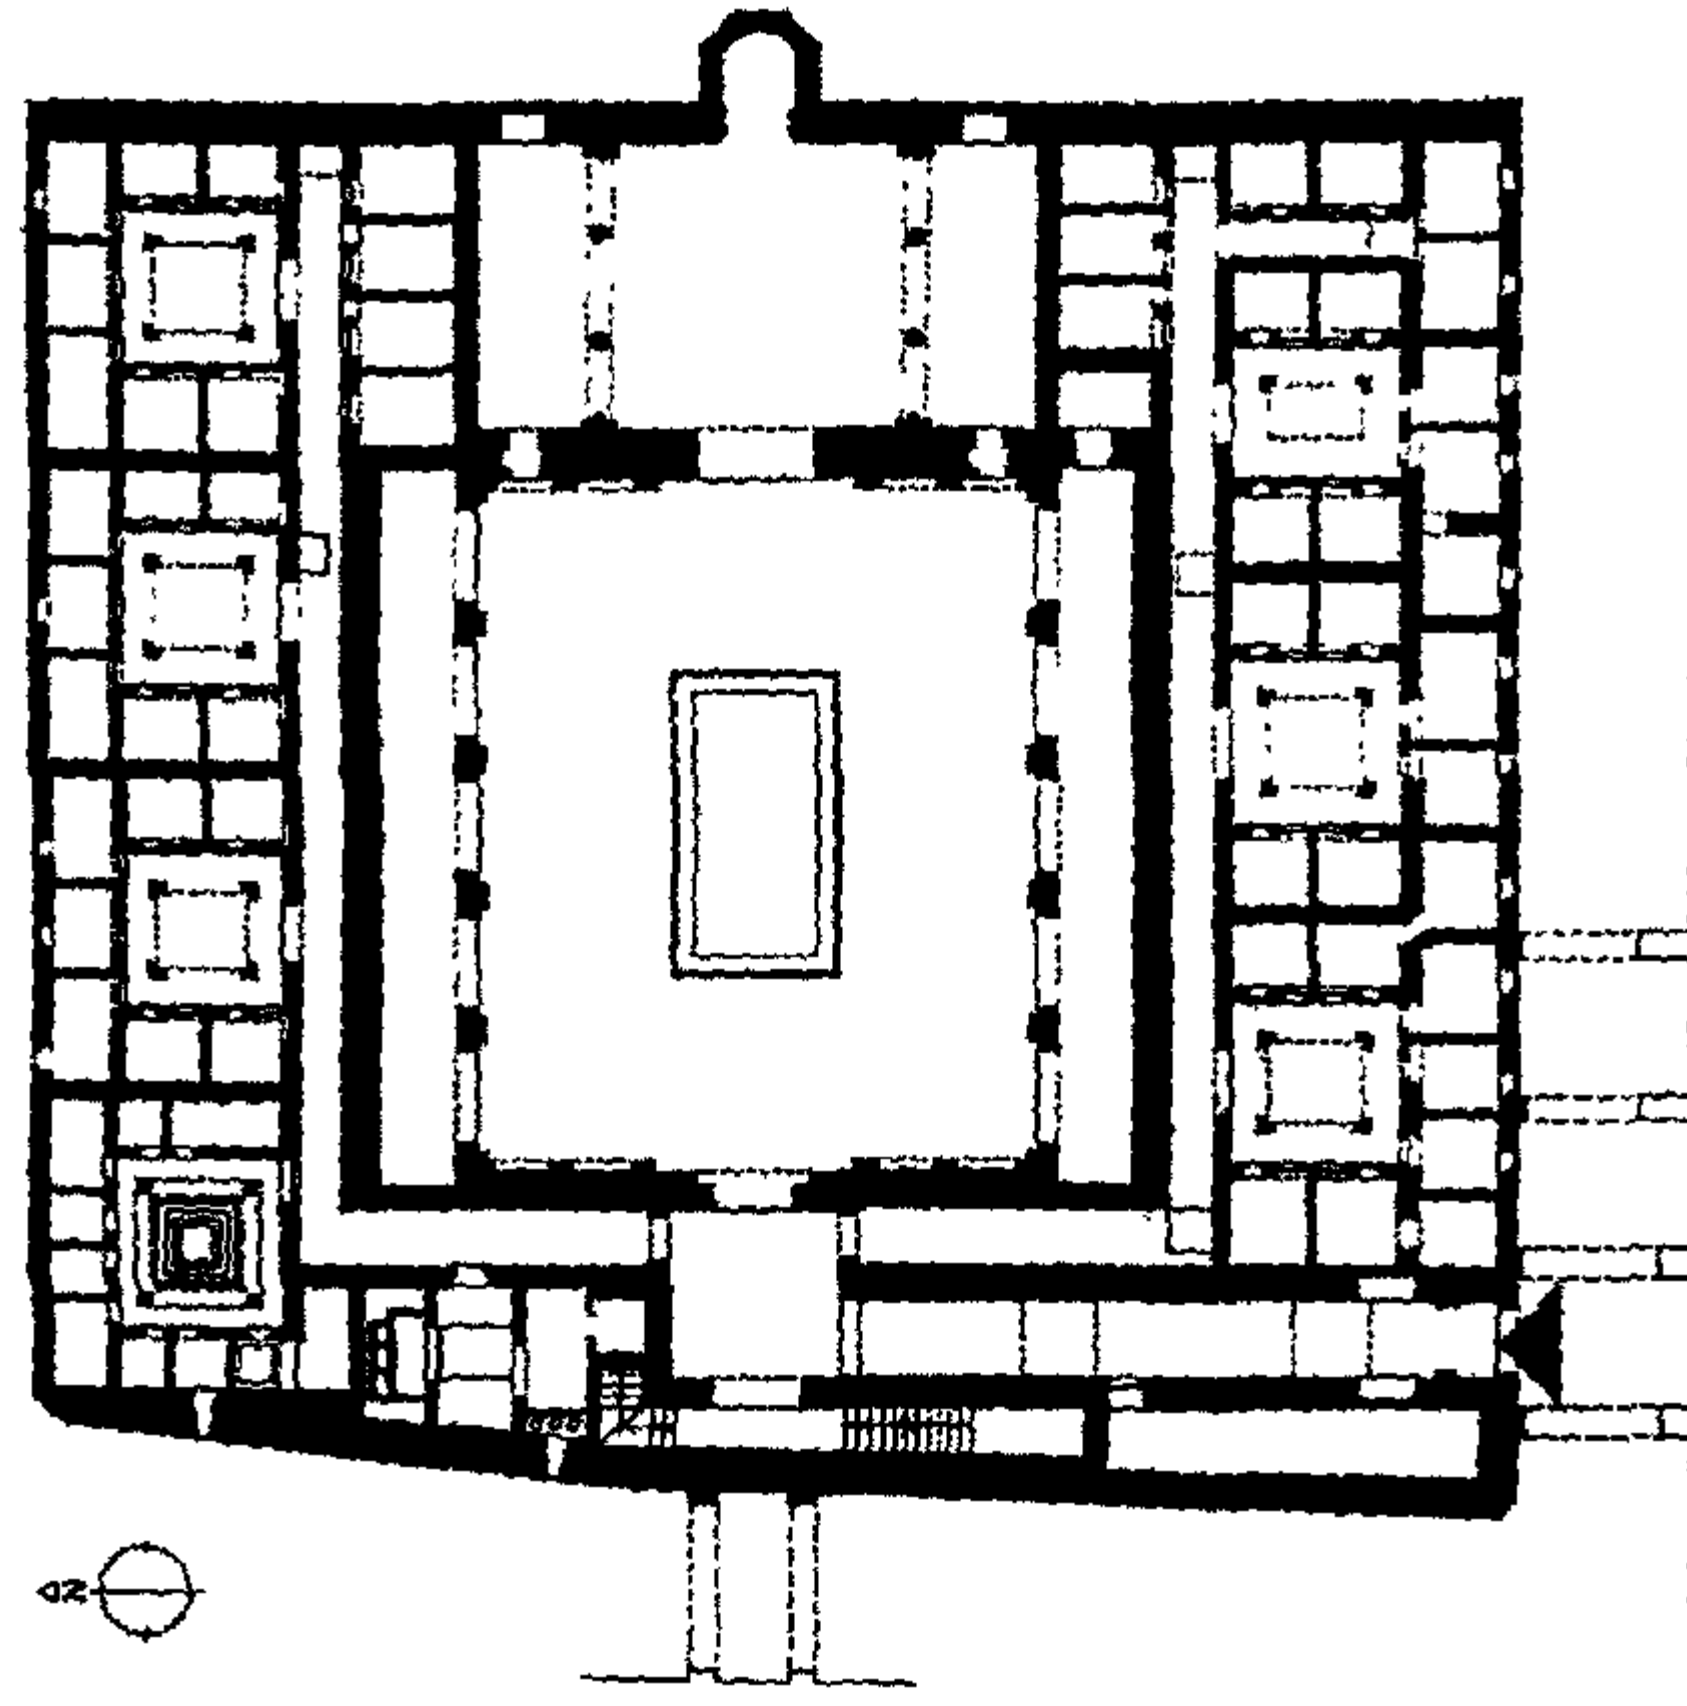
مسقط أفقي لمسجد الحمراء بفاس الجديد.
